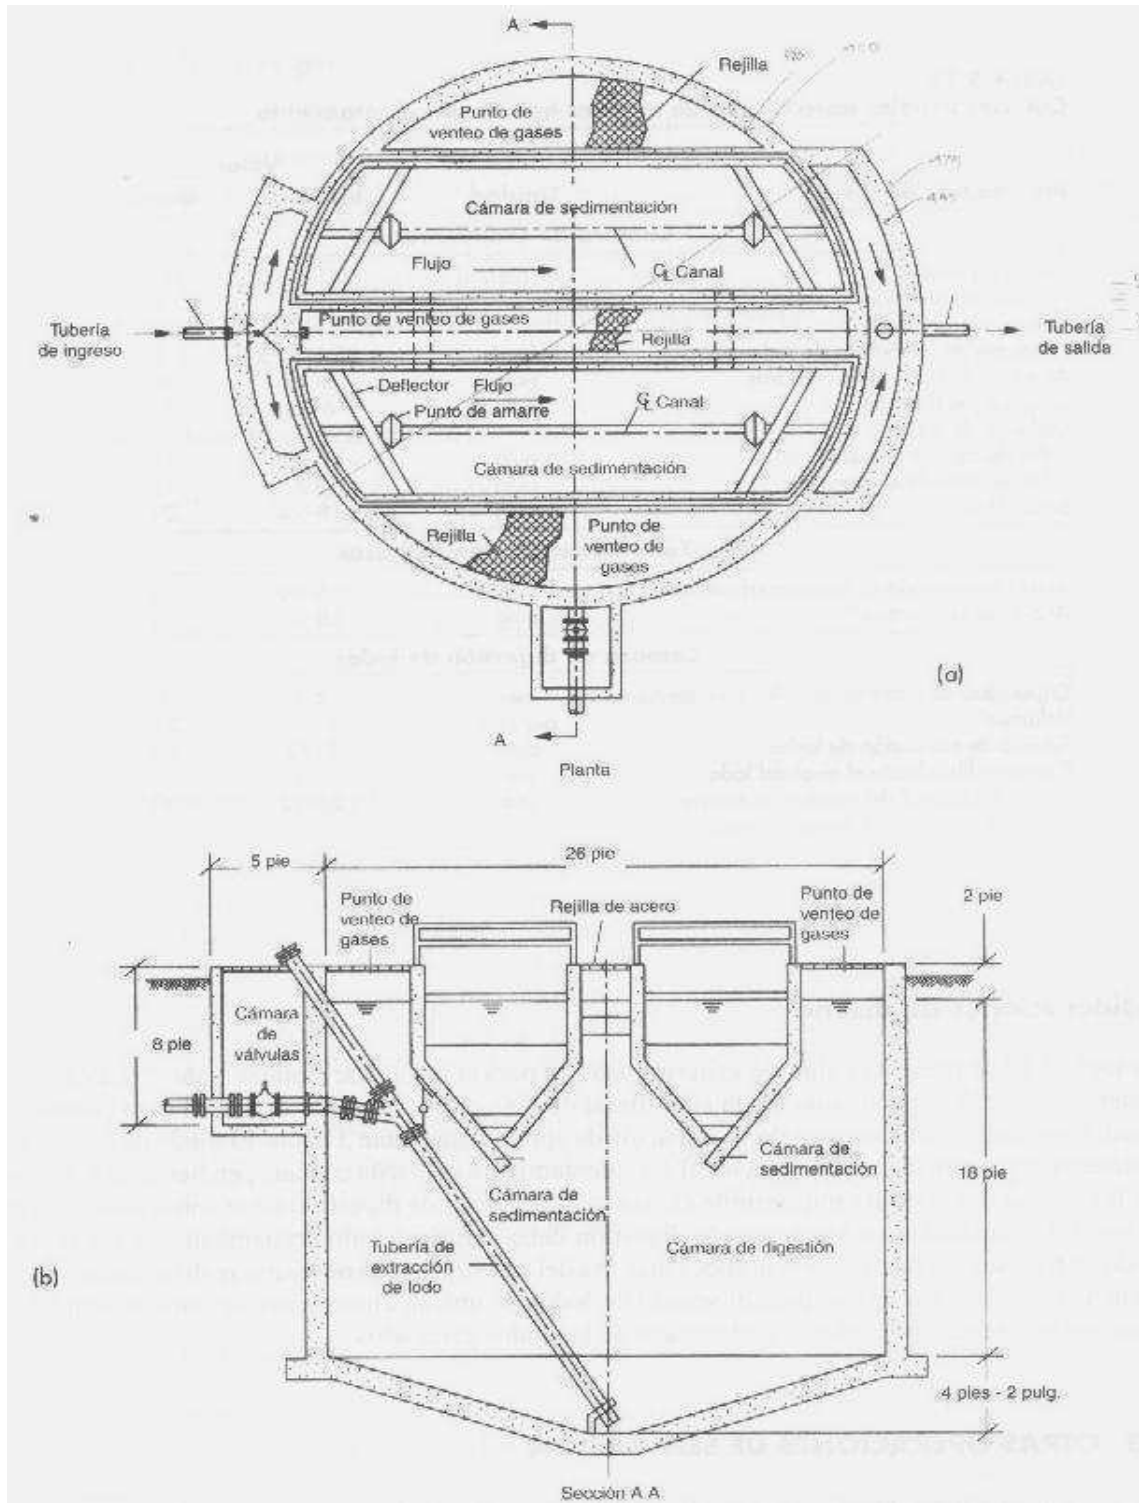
Tanque Imhoff circular. (a) Planta, (b) Sección transversal.
